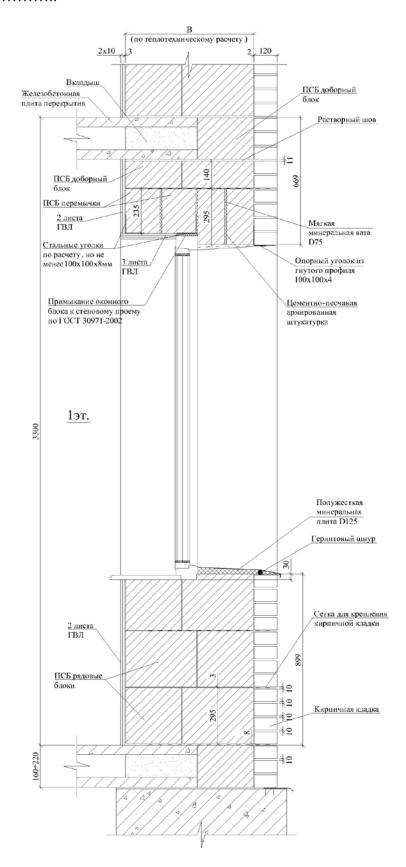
Несущая стена из полистиролбетонных блоков с фасадной облицовкой толщиной в 0,5 кирпича. Вертикальный разрез по оконному проему
